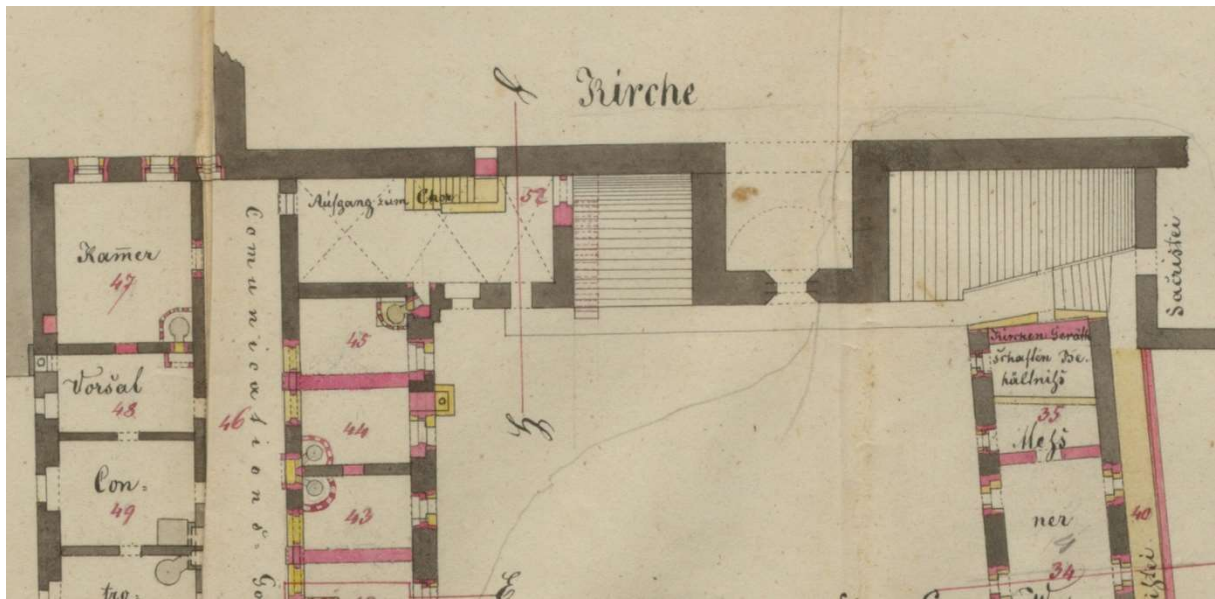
Ausschnitt aus dem Obergeschoß-Grundriss des Umbauplans von 1848 (u.a Einbau von Arrestzellen). Detail über dem nördlichen Kreuzgangflügel mit der Darstellung des einstigen Emporenaufgangs und dem an der Nordseite des Hofes entlang geführten Laufgangs. (Kärntner Landesarchiv, AT-KLA 183-C-804 Ak)
